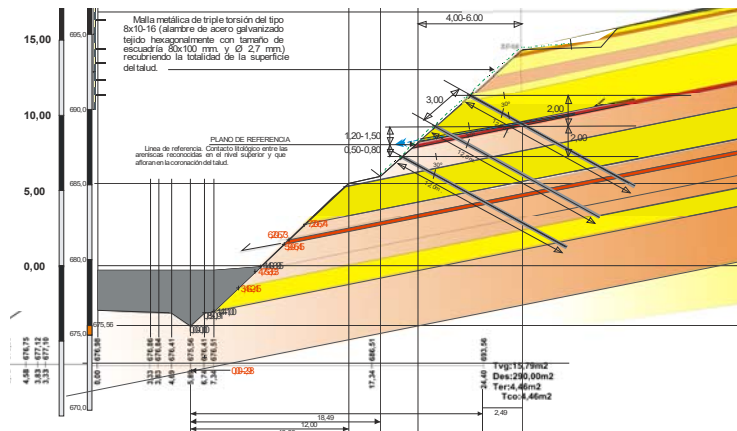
Sección tipo de la reparación con bulones en la zona en la que existen dos potenciales planos de rotura
